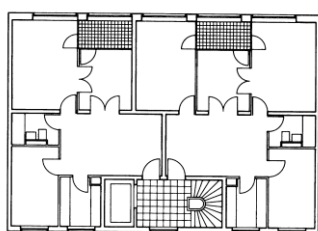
Planta do piso 1, identificação do espaço comum. (Desenho da autora)
